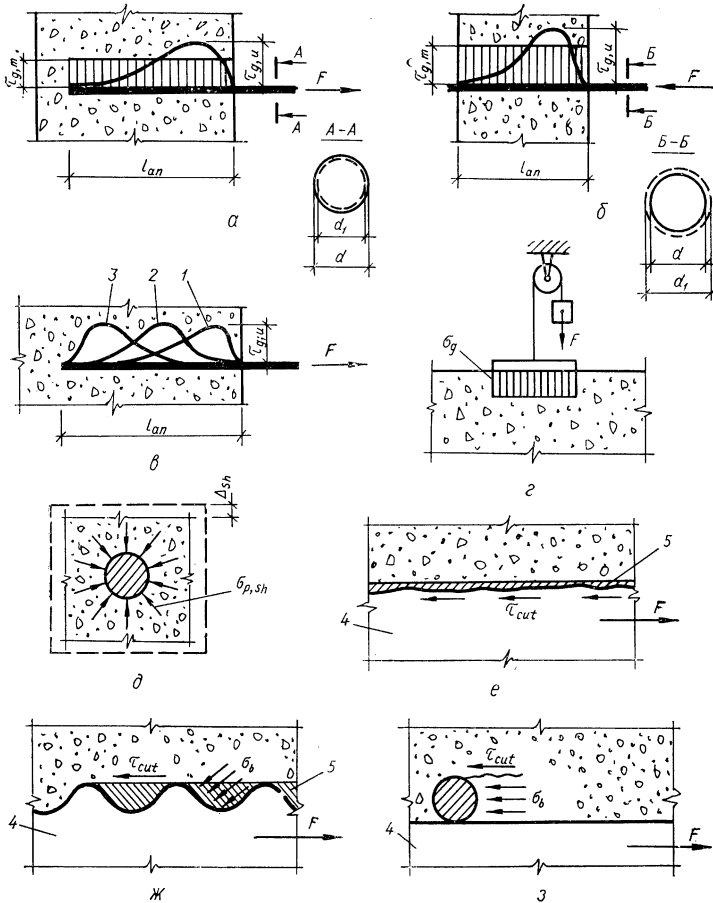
Зчеплення арматури з бетоном: *a* – при висмикуванні стержня; *б* – те саме, при протисканні; *в* – послідовність зміни епюри напружень у бетоні під час висмикування стержня (1...3); *г* – зчеплення арматури з бетоном, обумовлене склеюванням сталі з бетоном; *д* – те саме, обтискуванням арматурного стержня бетоном, спричинене усадкою; *е* – те саме, механічним зчепленням при гладкій арматурі; *ж* – те саме, періодичного профілю; *з* – те саме, у зварних сітках та каркасах; 4 – арматурний стержень; 5 – зрізаний бетон
